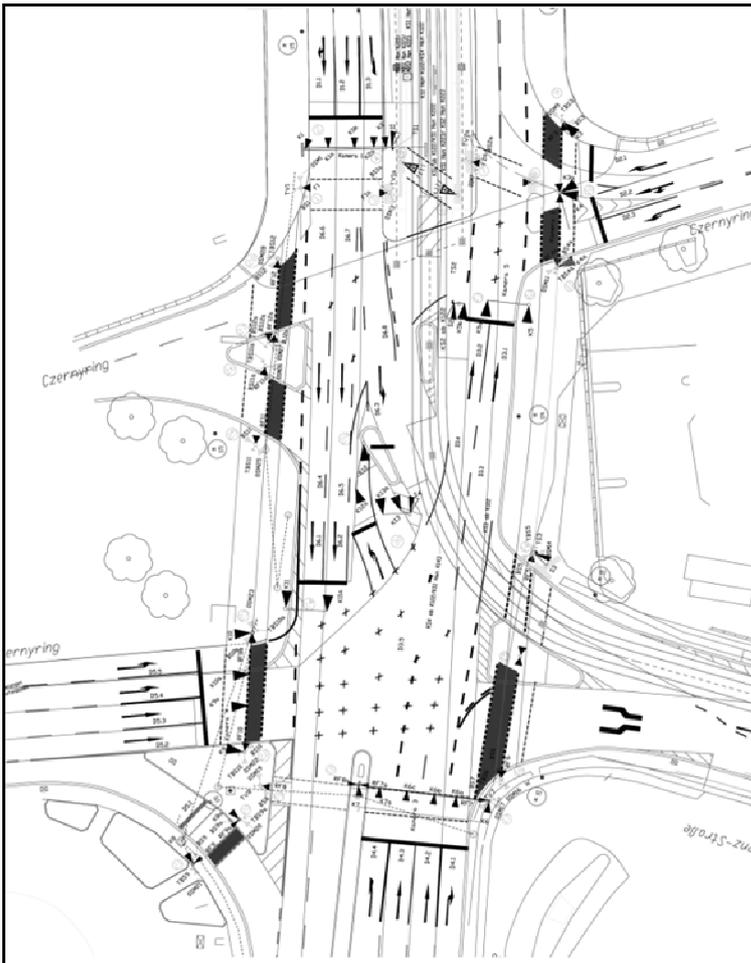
Signallageplan K122 Montpellierbrücke Status Quo
